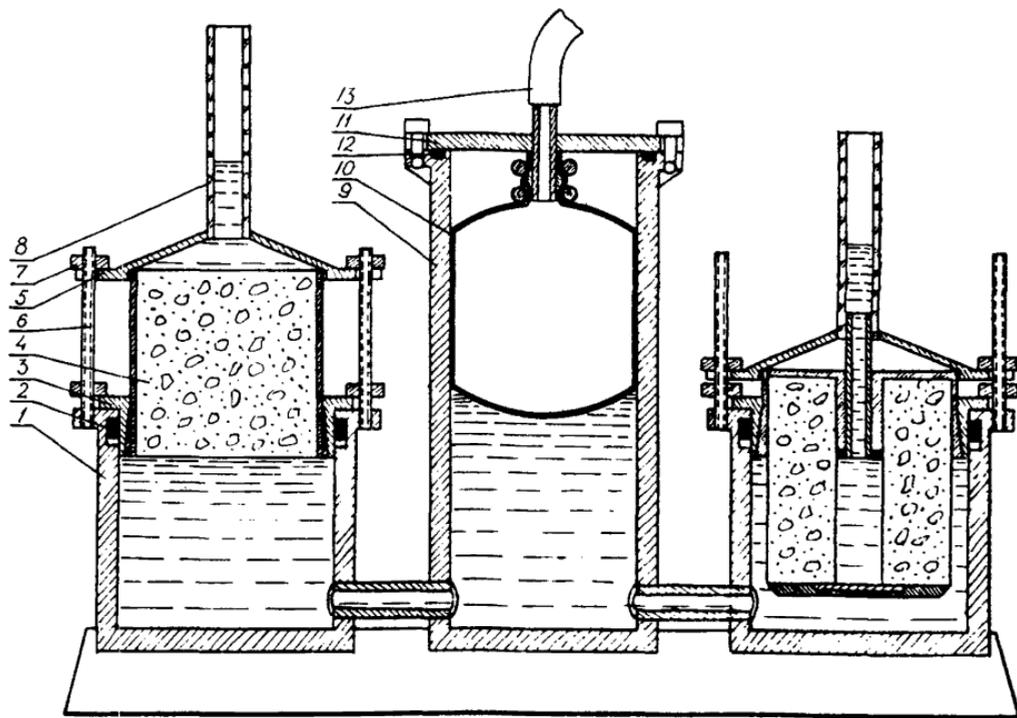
Прибор для фильтрационных испытаний бетона: 1 - фильтрационная ячейка; 2 - самоуплотняющийся резиновый жгут; 3 - охватывающий образец пояс с кольцом; 4 - бетонный образец; 5 - водосборная воронка; 6 - стойка крепления; 7 - ограничительные гайки; 8 - водомерная трубка; 9 - баллон ресивера; 10 - эластичная диафрагма; 11 - крышка ресивера; 12 - уплотнительное кольцо; 13 - воздуховод; Справа показана схема крепления в ячейке цилиндрического образца с осевым каналом для определения коэффициента радиальной фильтрации.
